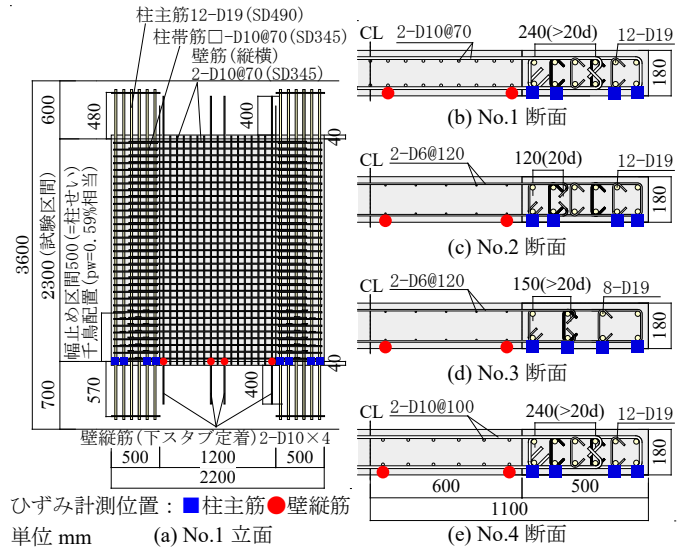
試験体配筋図および柱主筋と壁縦筋のひずみ計測位置
